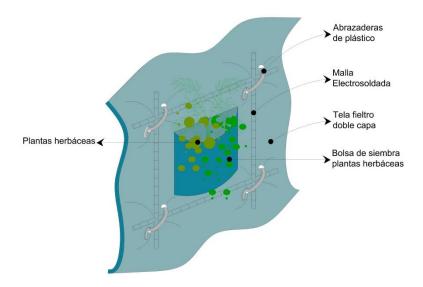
Detalle de amarre, tela fieltro con malla electro soldada. Fuente: Eduardo Rivadeneira
